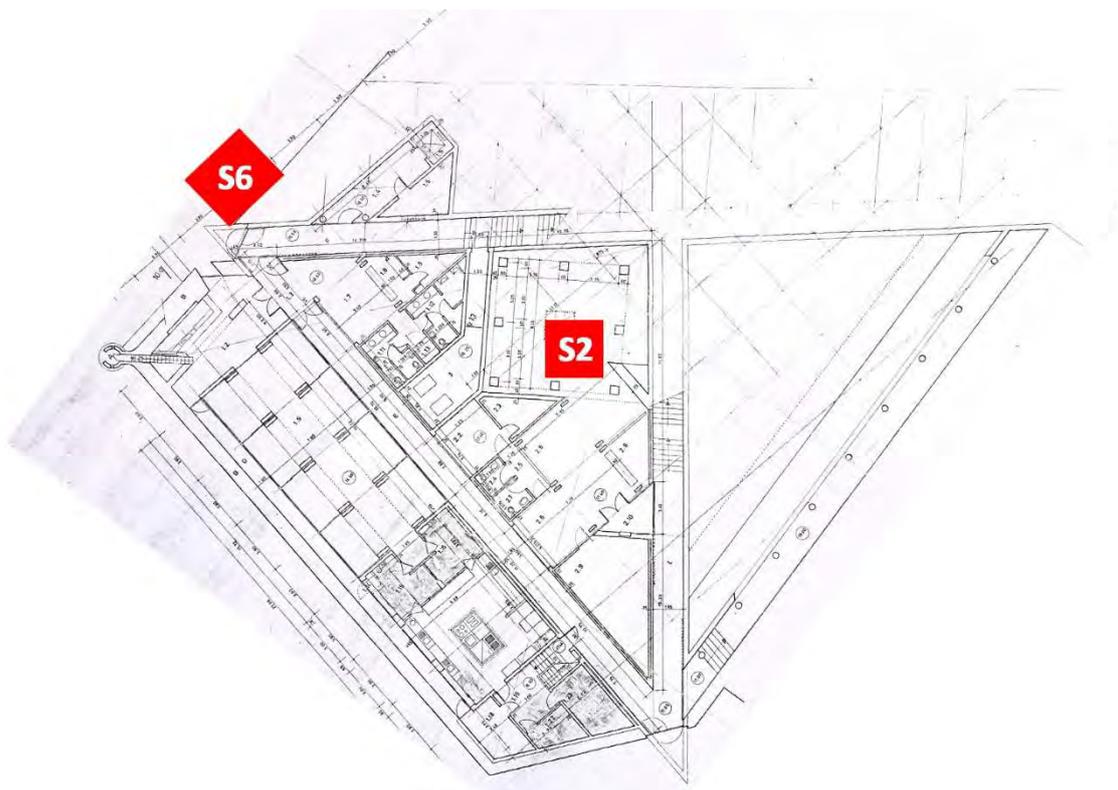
Localização das sondagens 2 e 6 sobre a planta do piso 0.
